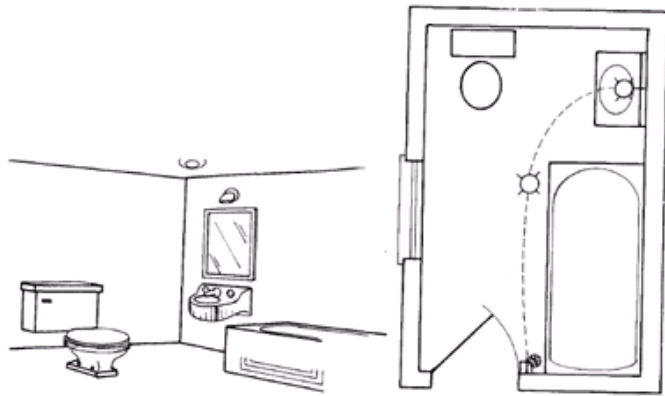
Perspectiva e instalación eléctrica de alumbrado para baño.
